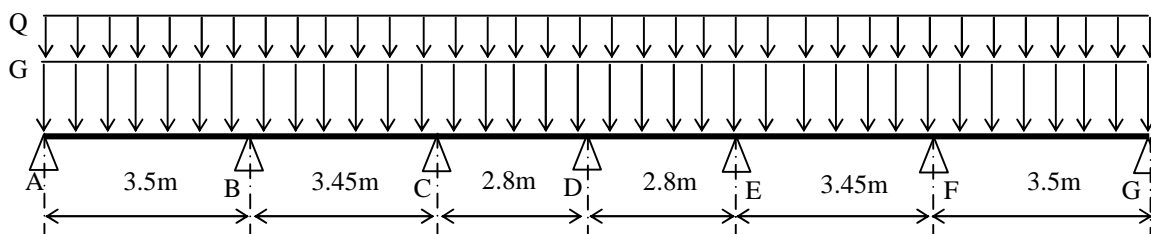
Schéma statique d'une poutrelle type (1).
